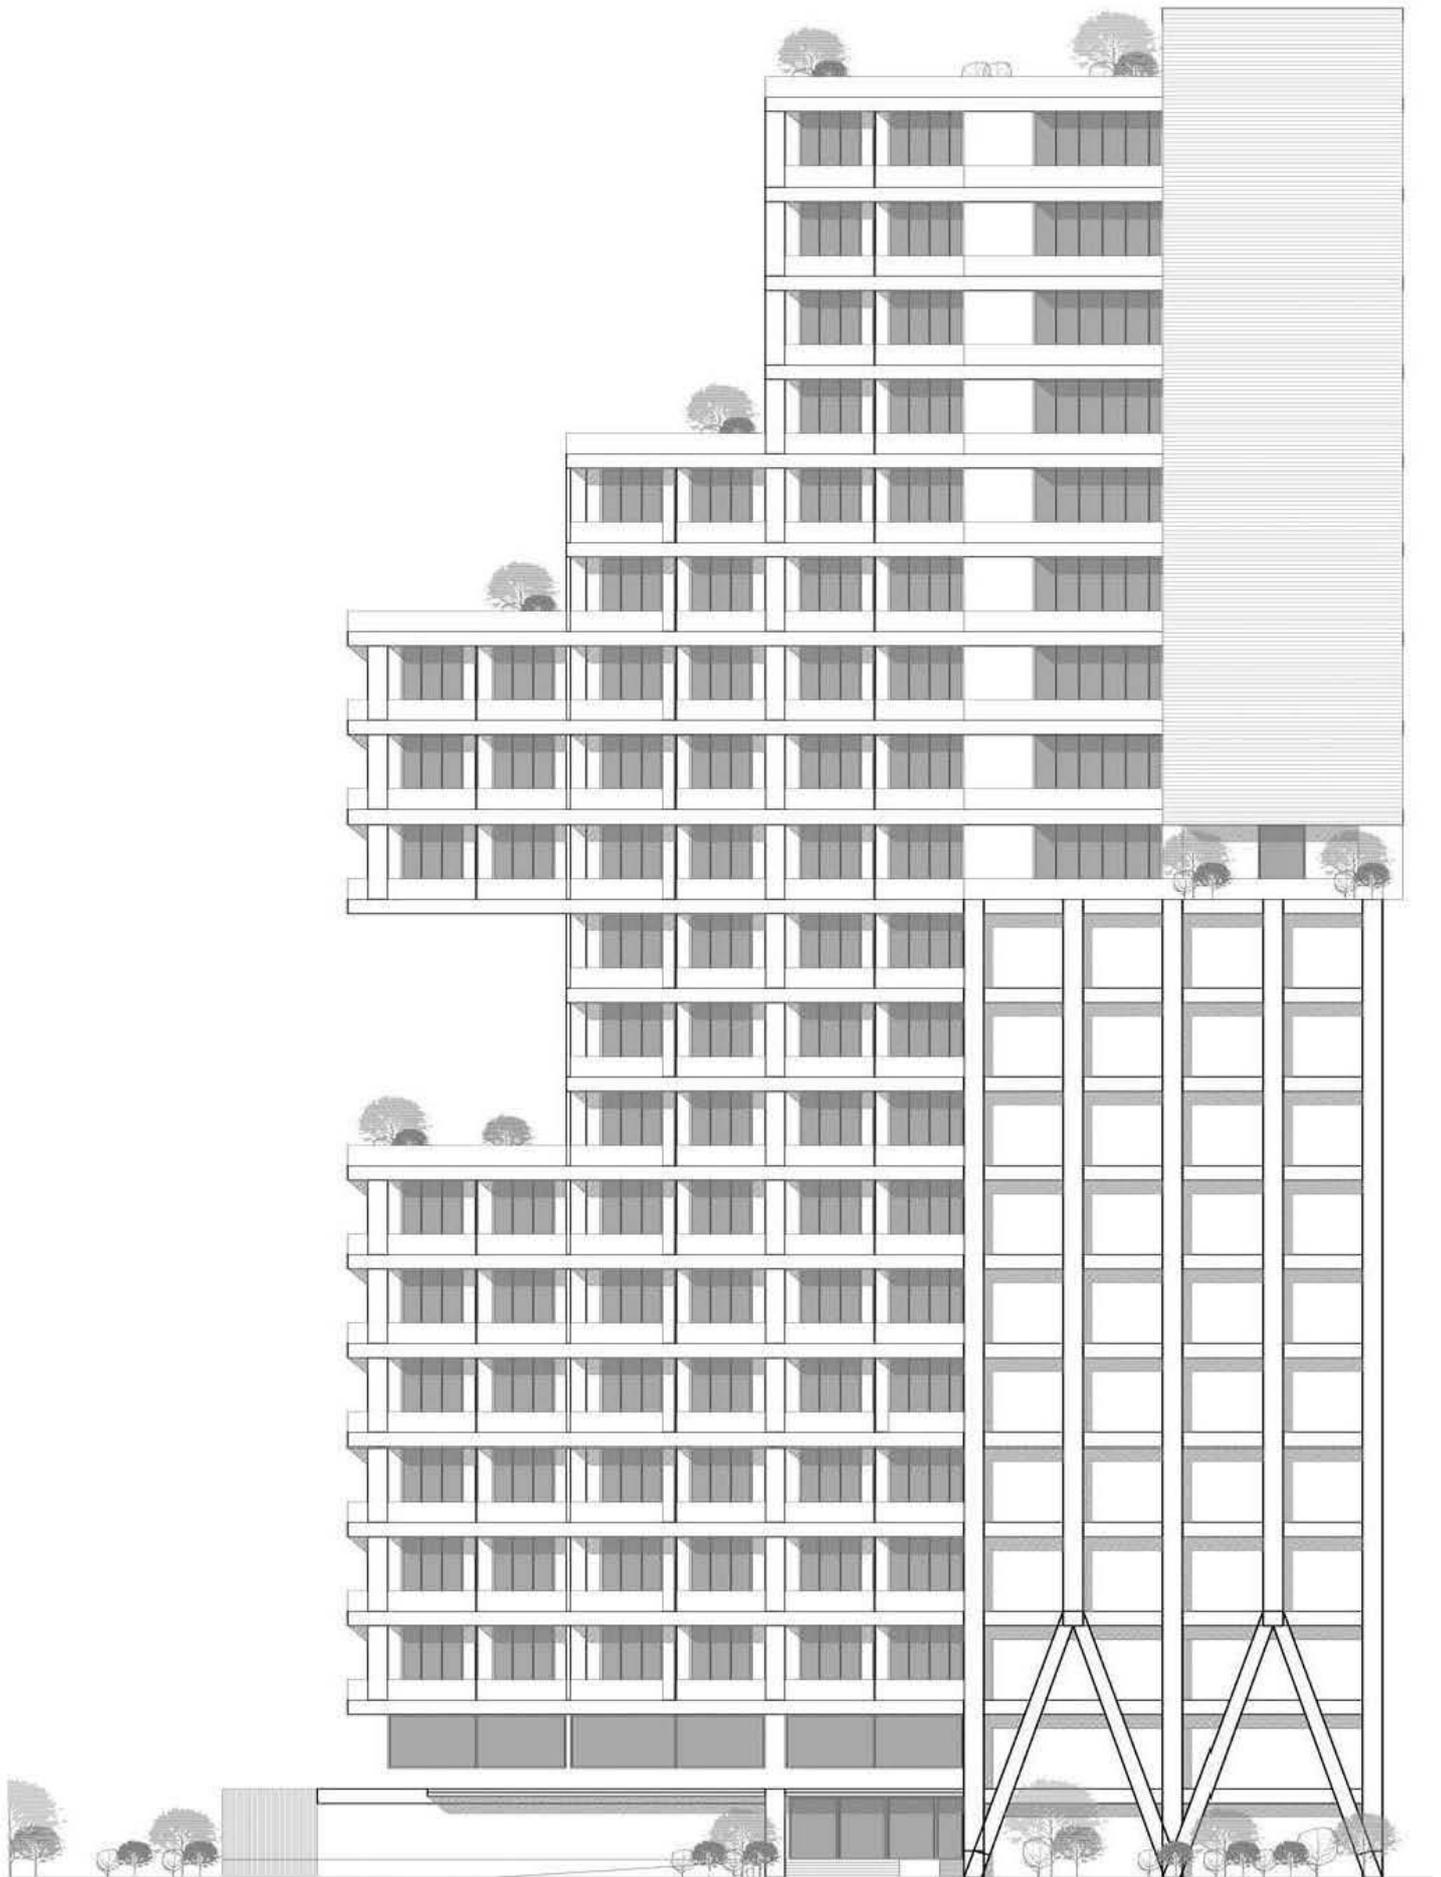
Fachada Oriente con cara a Paseo de la Reforma
